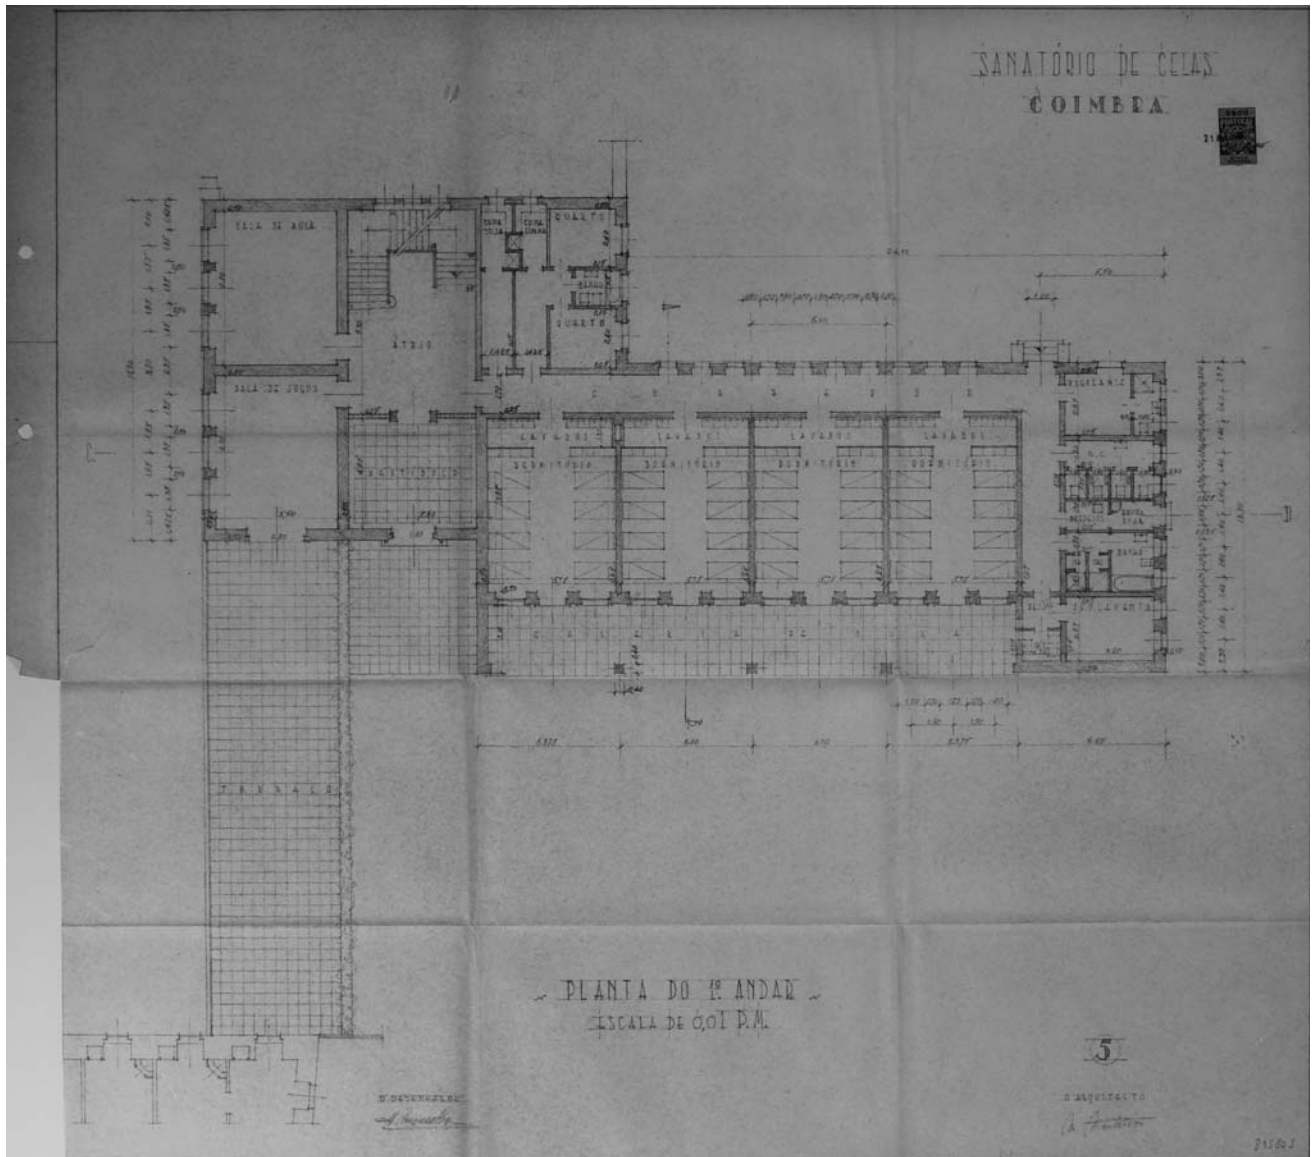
[Pavilhão para crianças] - Planta do 1º. Andar. M. Montalvão. 1958. 1958(m.). SIPA: DES\_815805.
